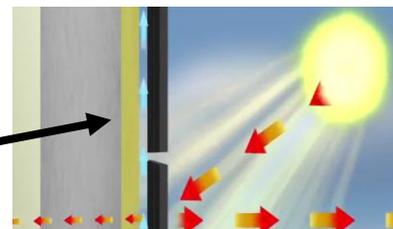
Détail protection du rayonnement solaire/source : Les principes de la façade ventilée, par Eternit - YouTube
